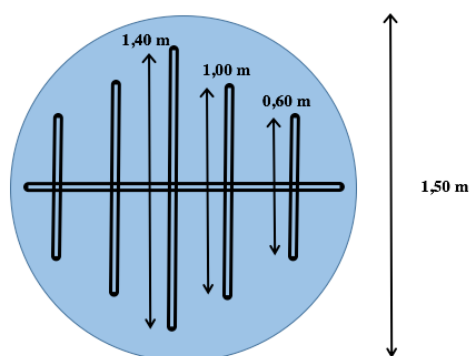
Planta baixa da distribuição do efluente via superficial no SAC.
